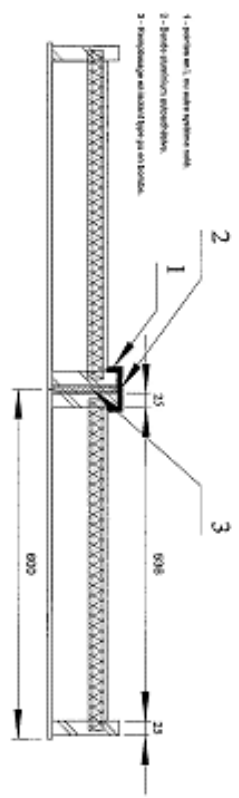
Principe d'assemblage des calissons sous-face plâtre.
